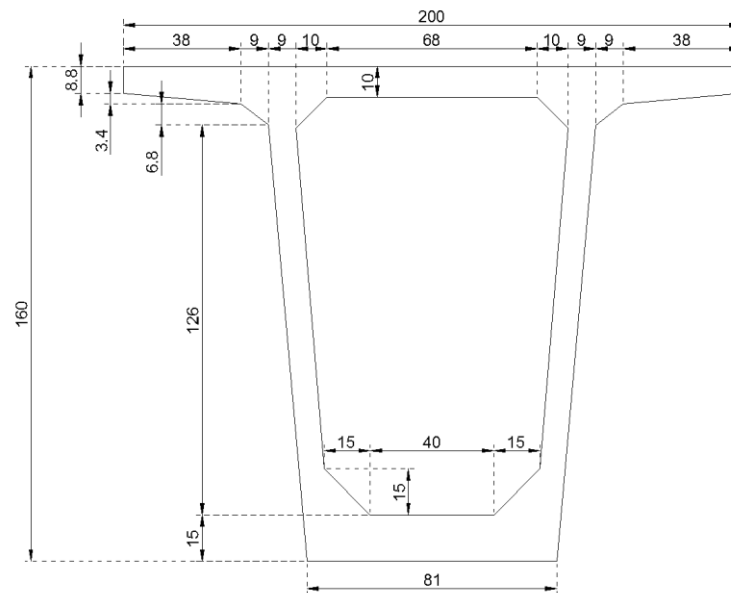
Detalle sección de vigas. (Unidades: cm).
